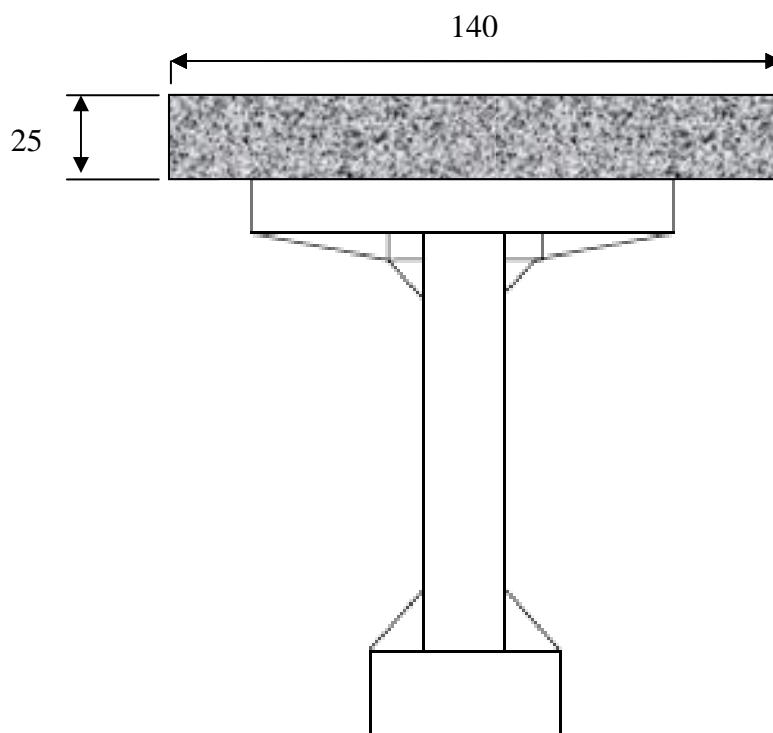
La section médiane de la poutre en BA plus l'hourdis général.
